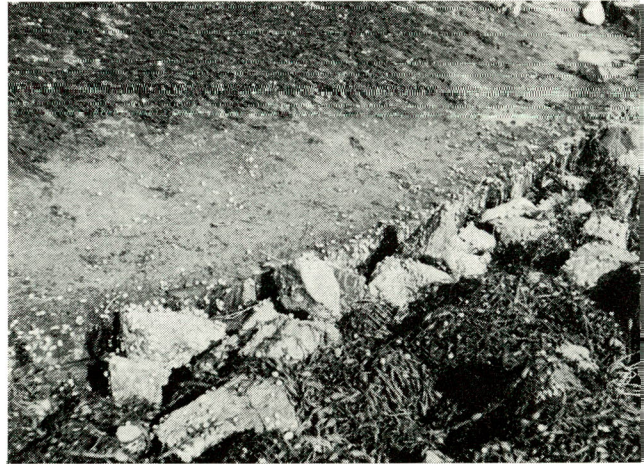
Teenconstructie van de asfaltglooiing aan de ringdijk bij Schelphoek aan de zuidkust van Schouwen.
